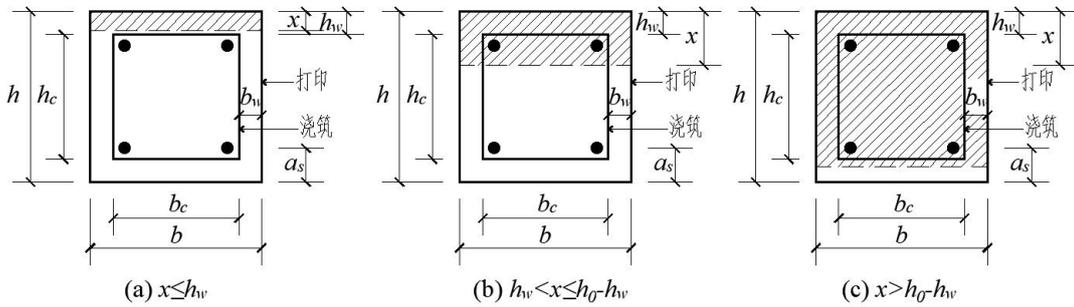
矩形截面偏心受压 3D 打印模板配筋混凝土构件正截面受压区高度位置示意图
